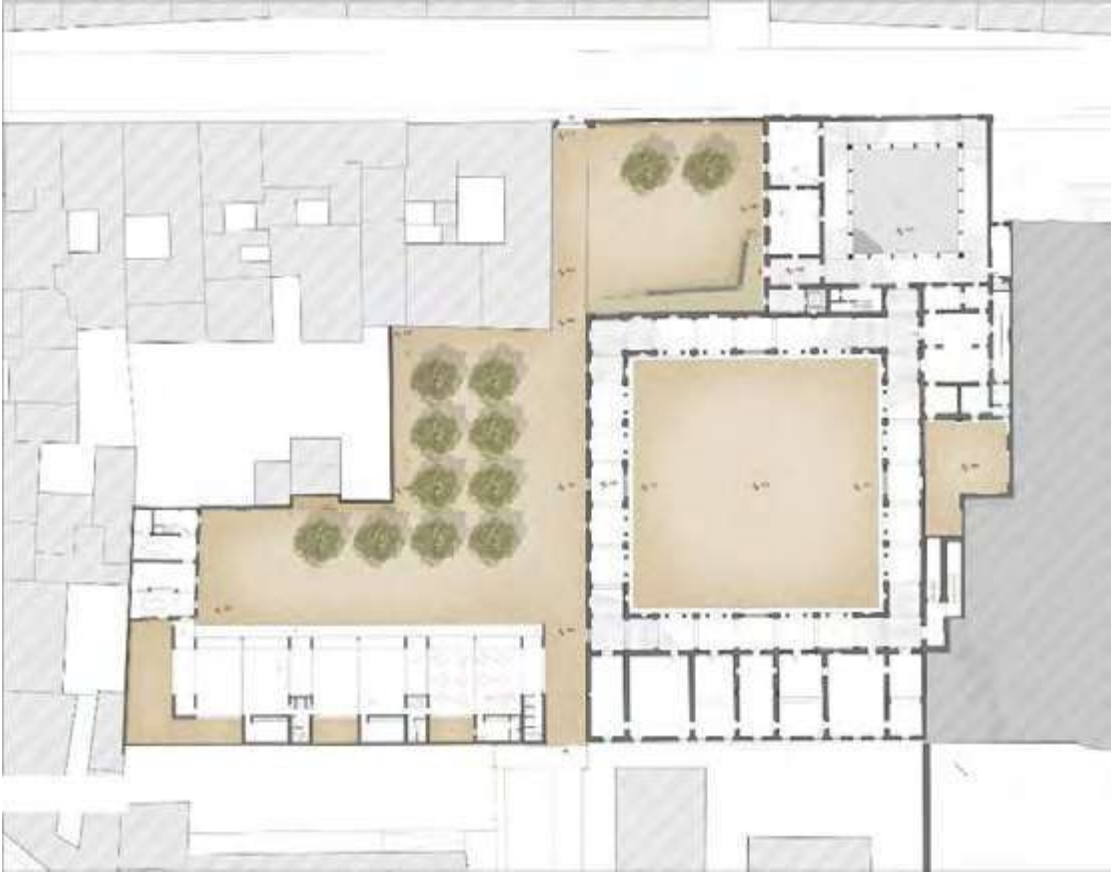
/ Fig.2: Planimetria di progetto - Modello del complesso monumentale
